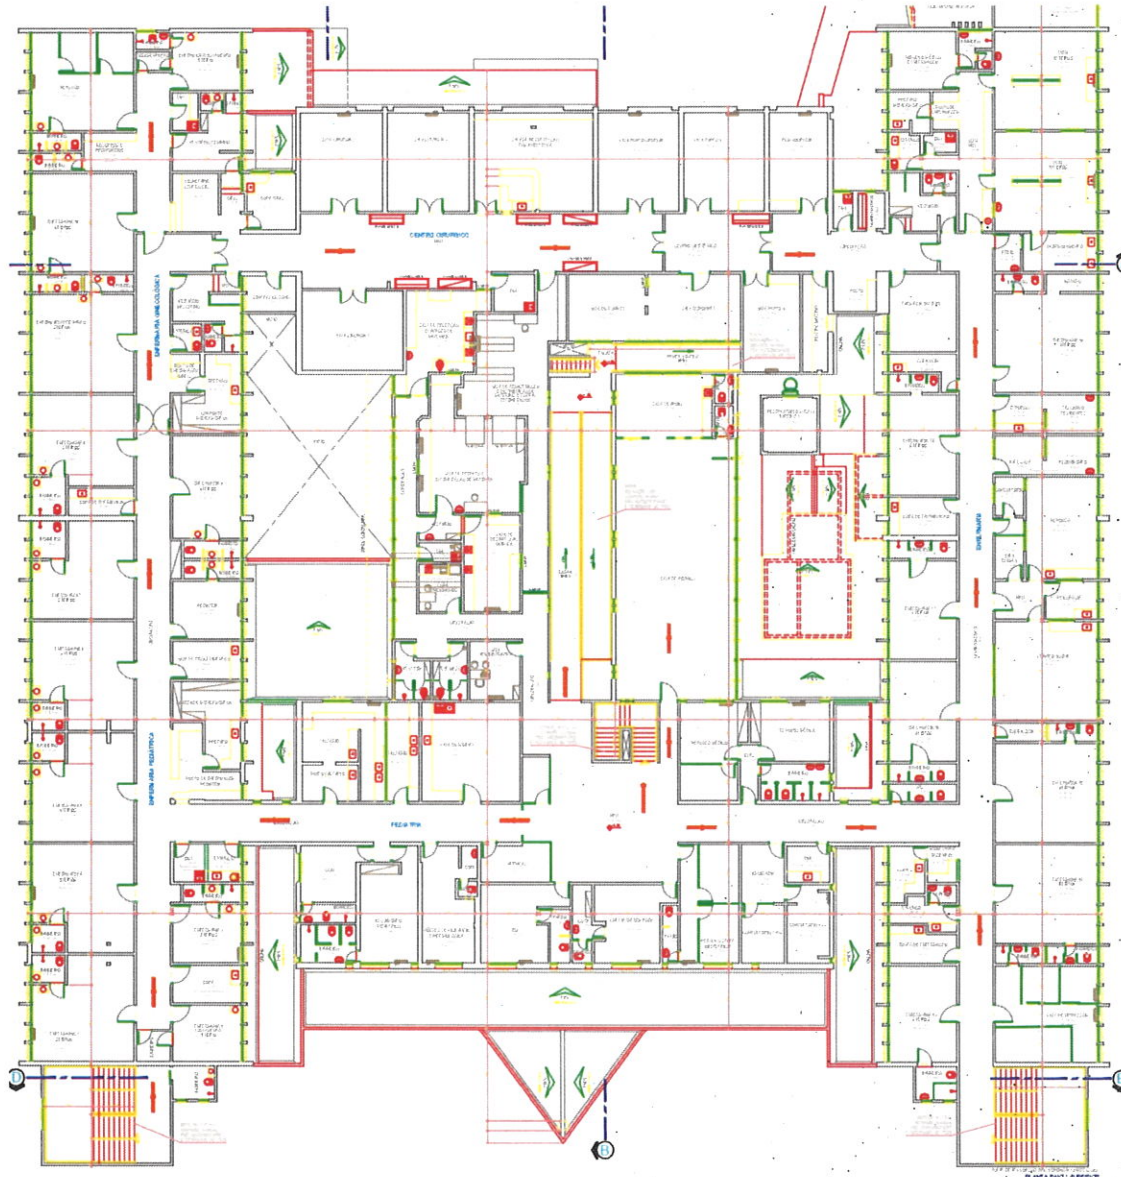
Planta baixa do 1º pavimento com todas Enfermarias
